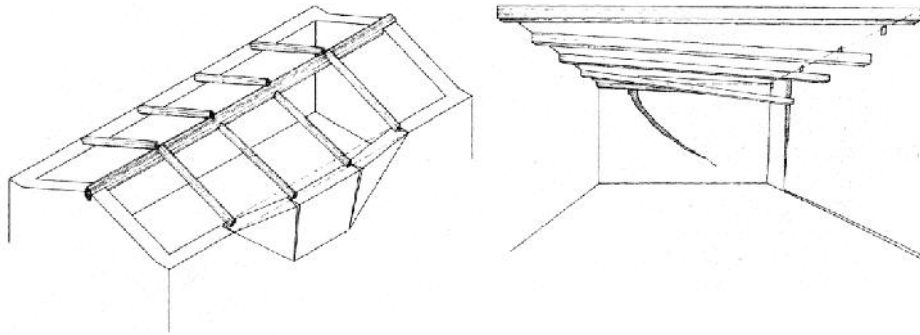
Sfilamento delle travi del tetto con effetto di spinta sulla parete (Giuffrè, 1993)
